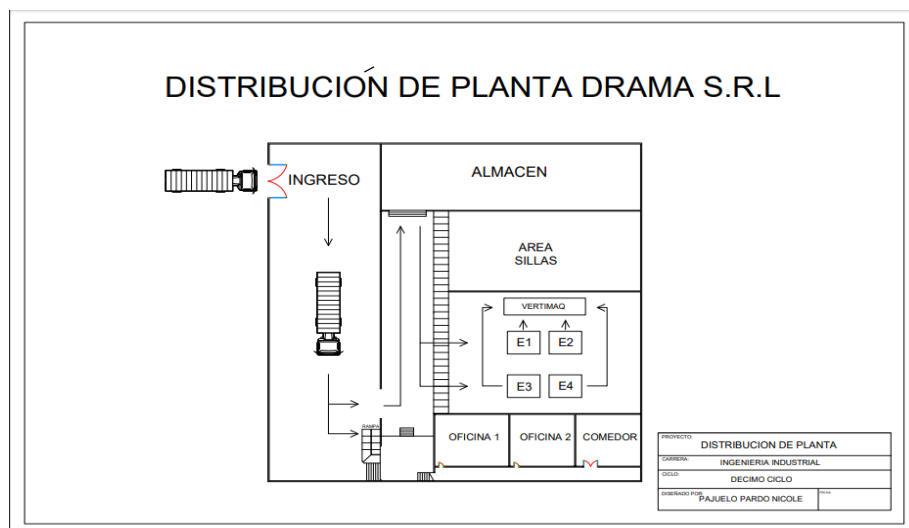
Distribución de planta de DRAMA SRL (Actual).
